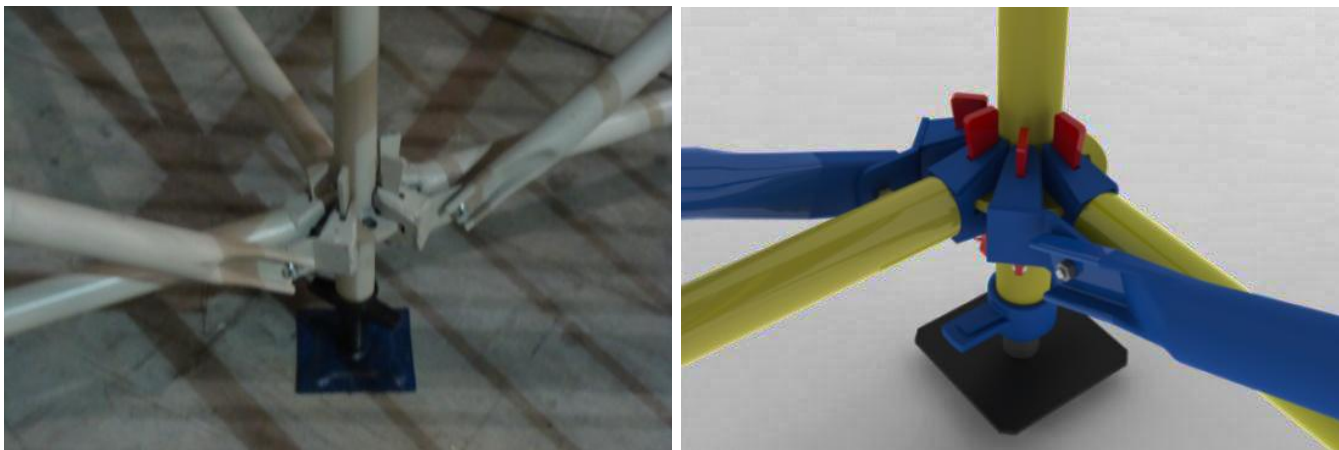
Опорные конструкции трибун клиновой сборки - винтовой домкрат.
